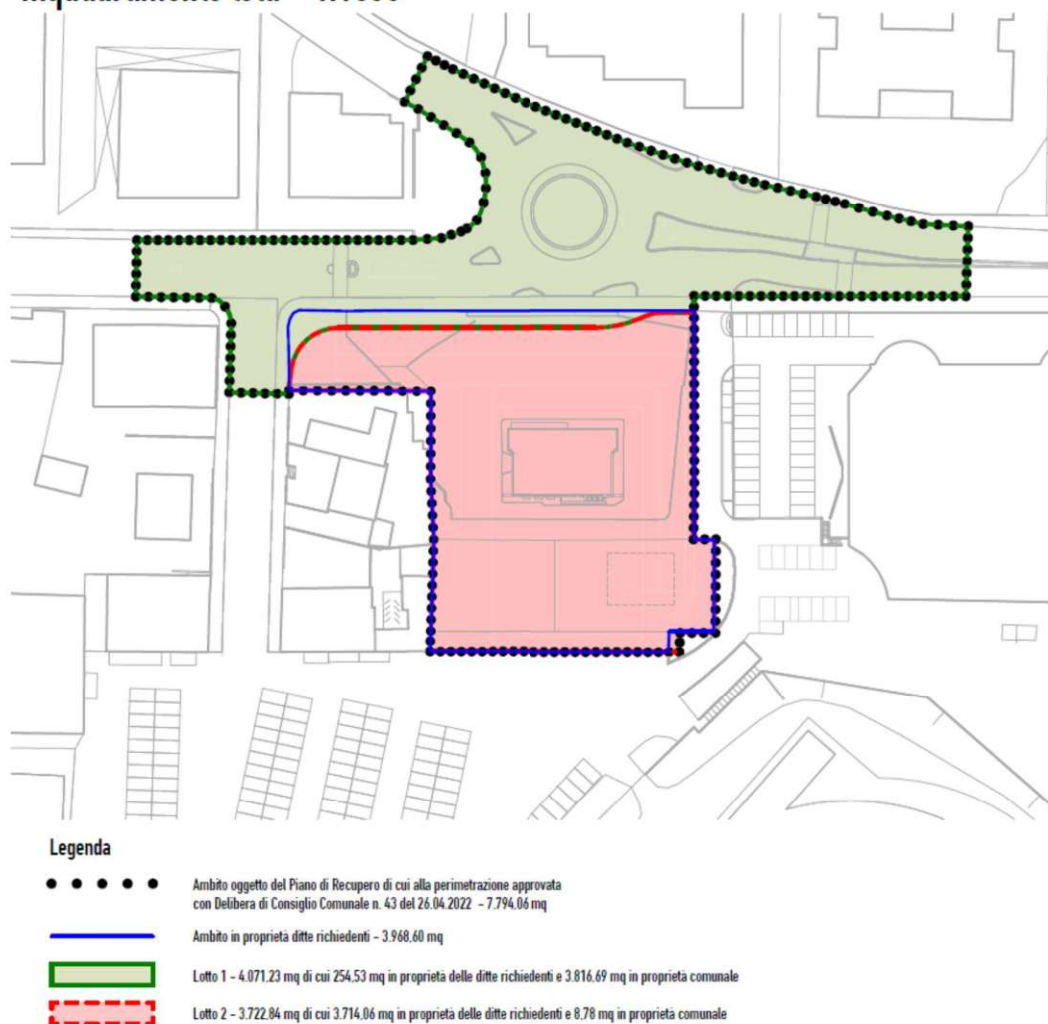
Planimetria dell'intervento previsto nel piano di recupero con indicazione dei lotti di intervento.
